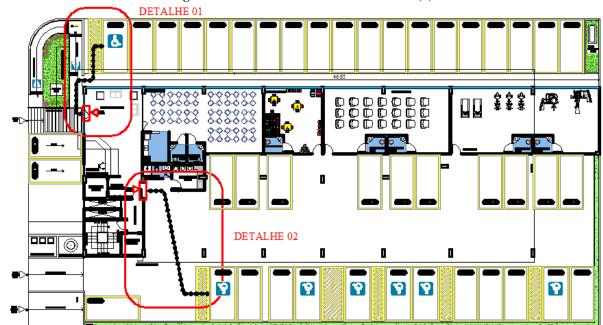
Planta Baixa - Pavimento térreo (1)
